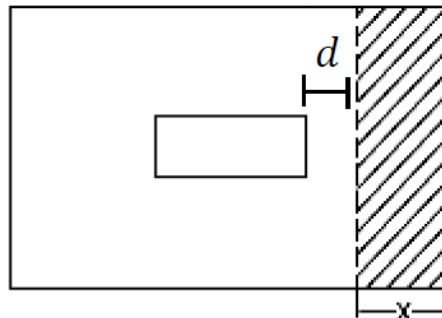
Sección crítica para la verificación del corte por flexión.
